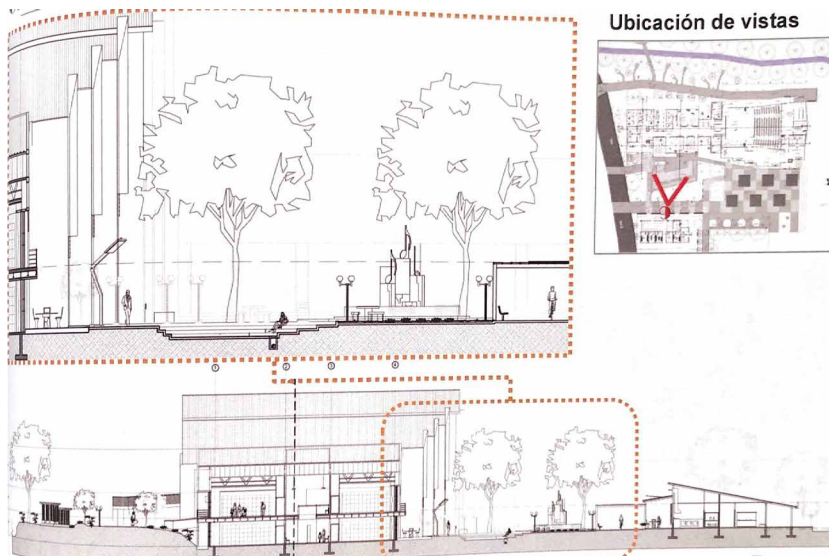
"Cortes y Ubicación de vistas de la propuesta"
